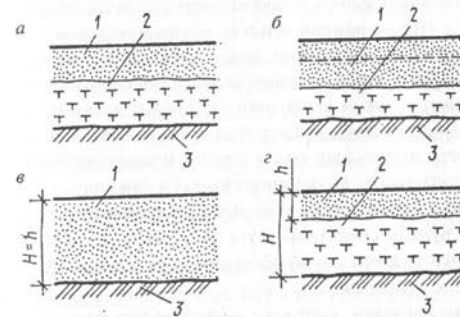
Строительство на заторфованных территориях: а — пригрузка слоем минерального грунта; б — подсыпка поверхности (насыпь); в — полное выторфывание с заменой изъятых слоев минеральными грунтами; г — то же, частичное; 1 — насыпь минерального грунта; 2 — торф; 3 — минеральное дно
